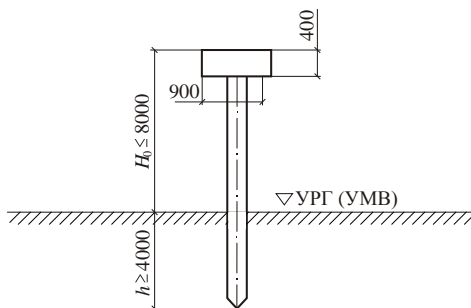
Конструкция промежуточной опоры с однорядным расположением свай
